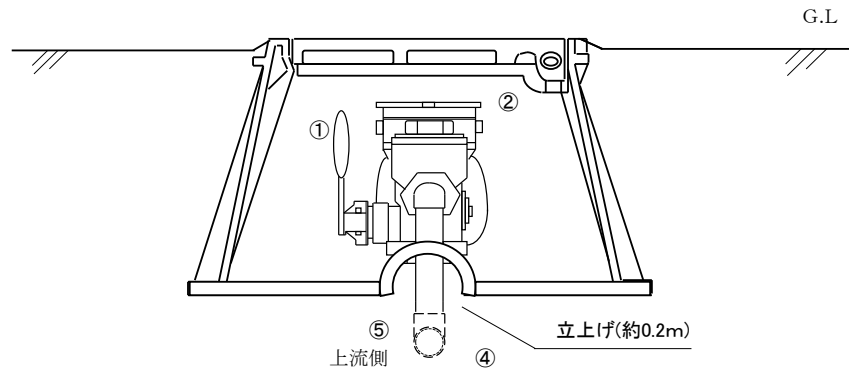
メータ設置及びメータボックス標準図(コンクリート又はコンクリートブロック)
